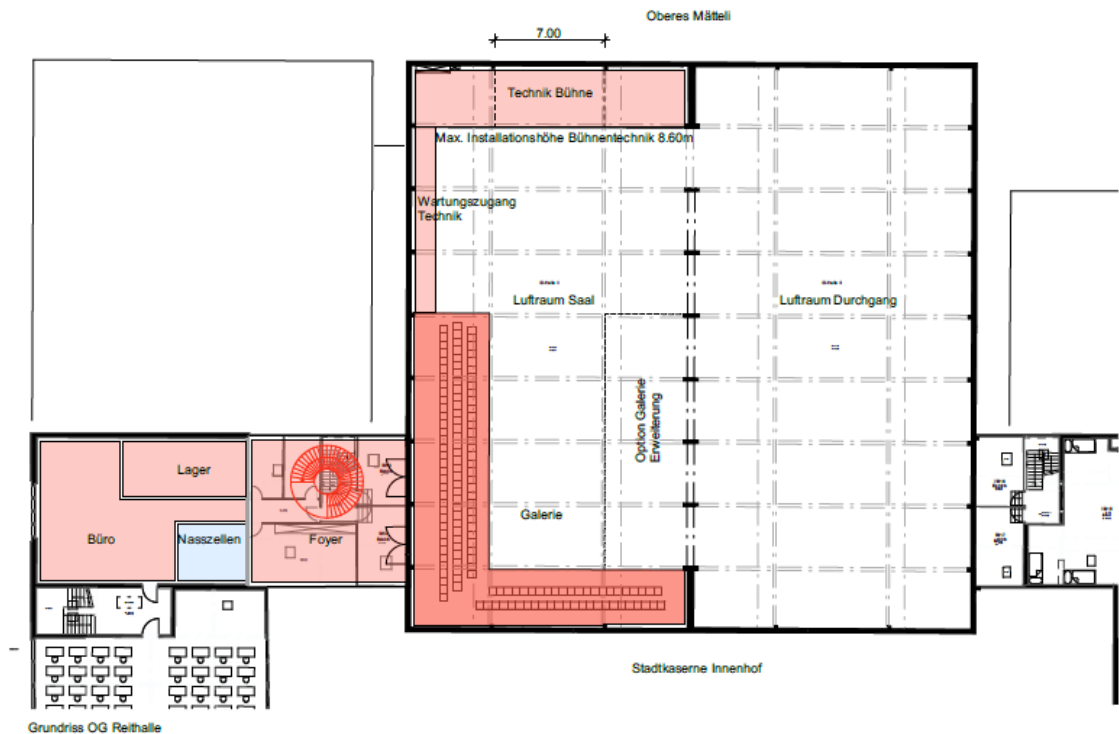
Grundriss OG Doppelreithalle
